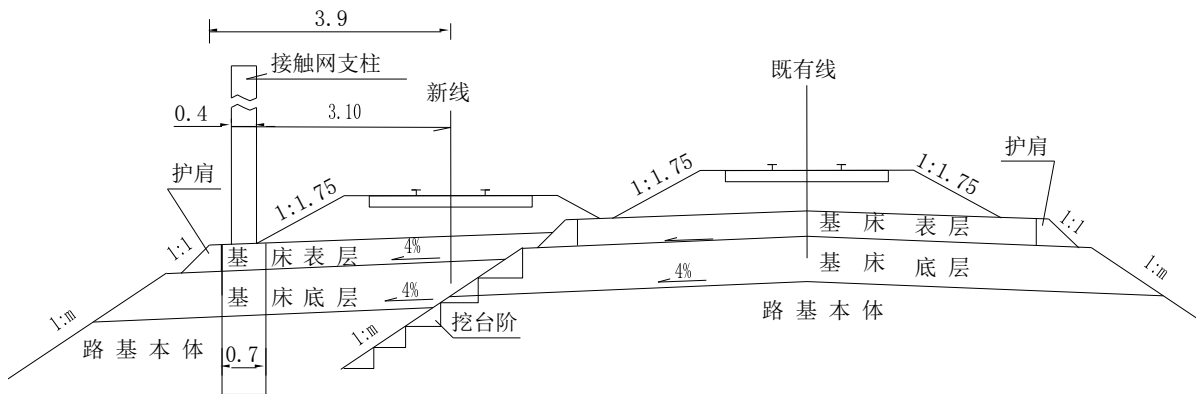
一侧帮宽增加股道路堤标准横断面示意图 (m)
